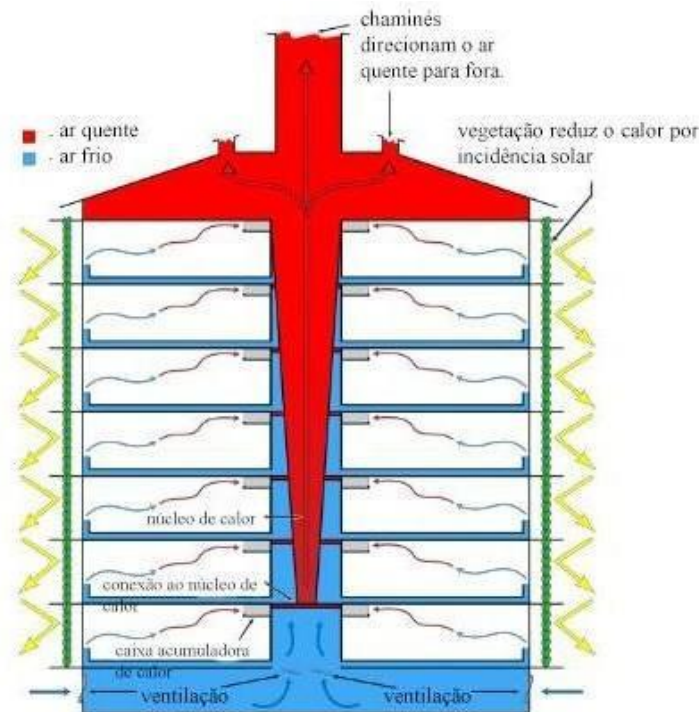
Sistema de ventilação do Eastgate Building. Fonte: Adaptado de https://en.wikipedia.org/wiki/Eastgate_Centre,_Harare
